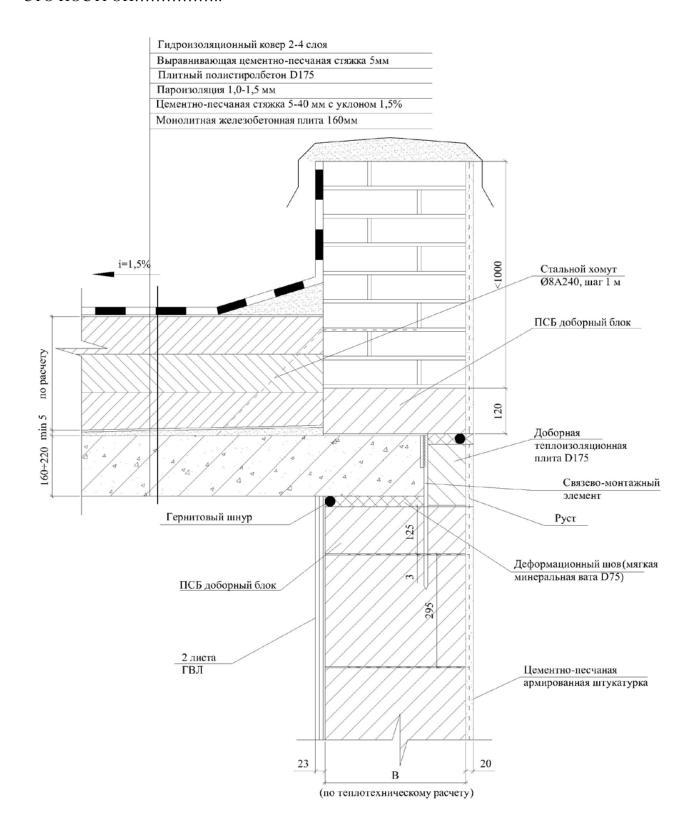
Утепление покрытия здания с использованием плитного полистиролбетона
